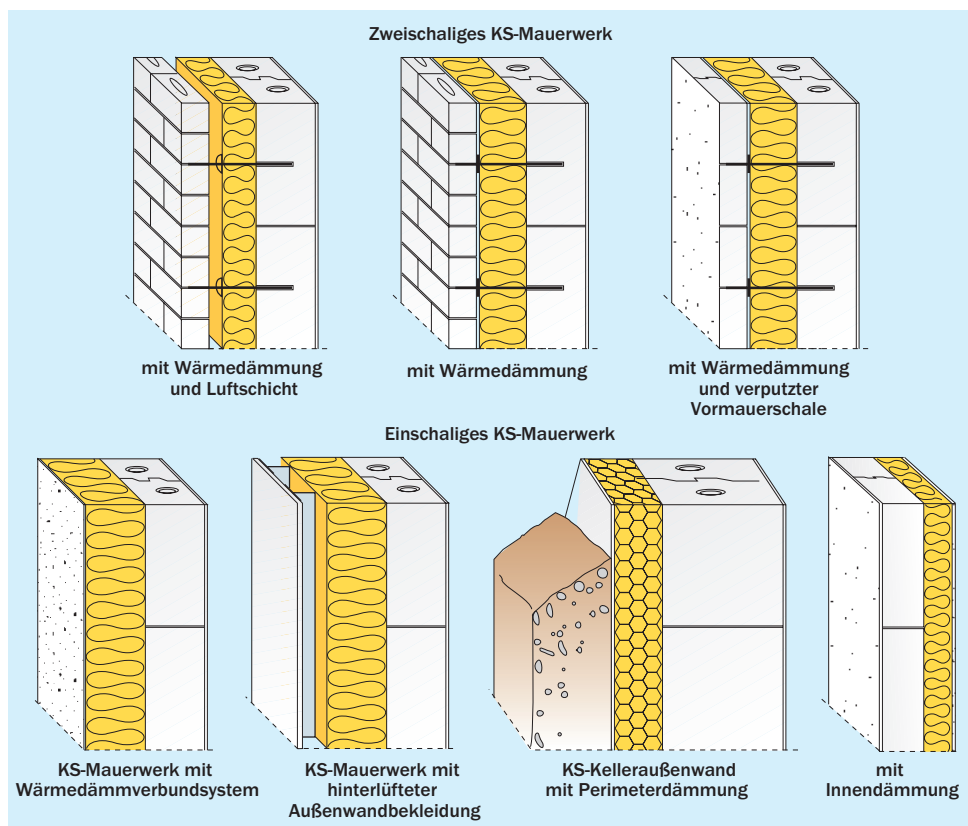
KS-Außenwandkonstruktionen für normal beheizte Gebäude
